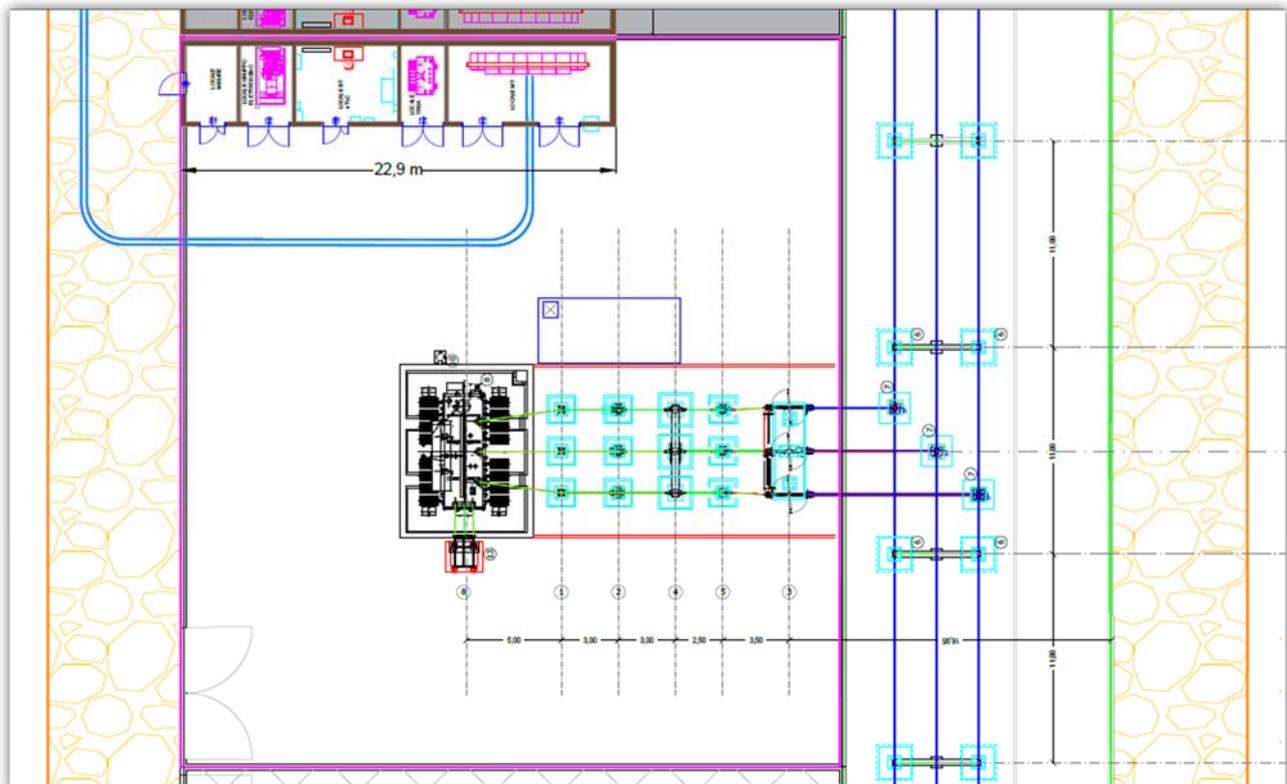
Planimetria elettromeccanica della SSE, con stralcio delle sbarre principali per la condivisione di Stallo
